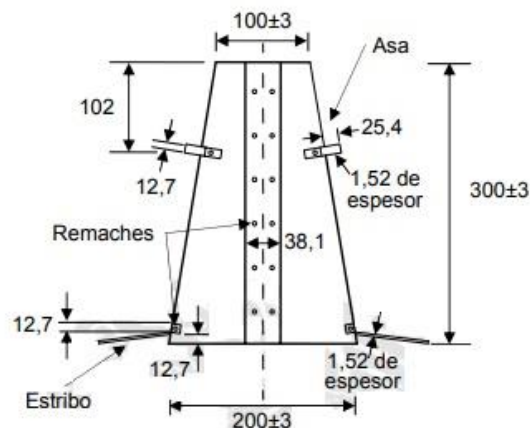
Cono estándar de revenimiento, alzado.¹¹¹
